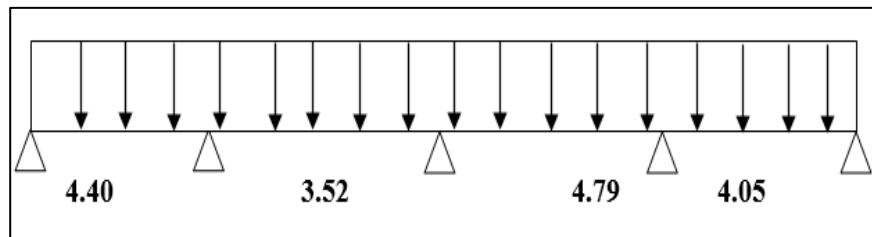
Schéma statique de la poutrelle à 4 travées.
